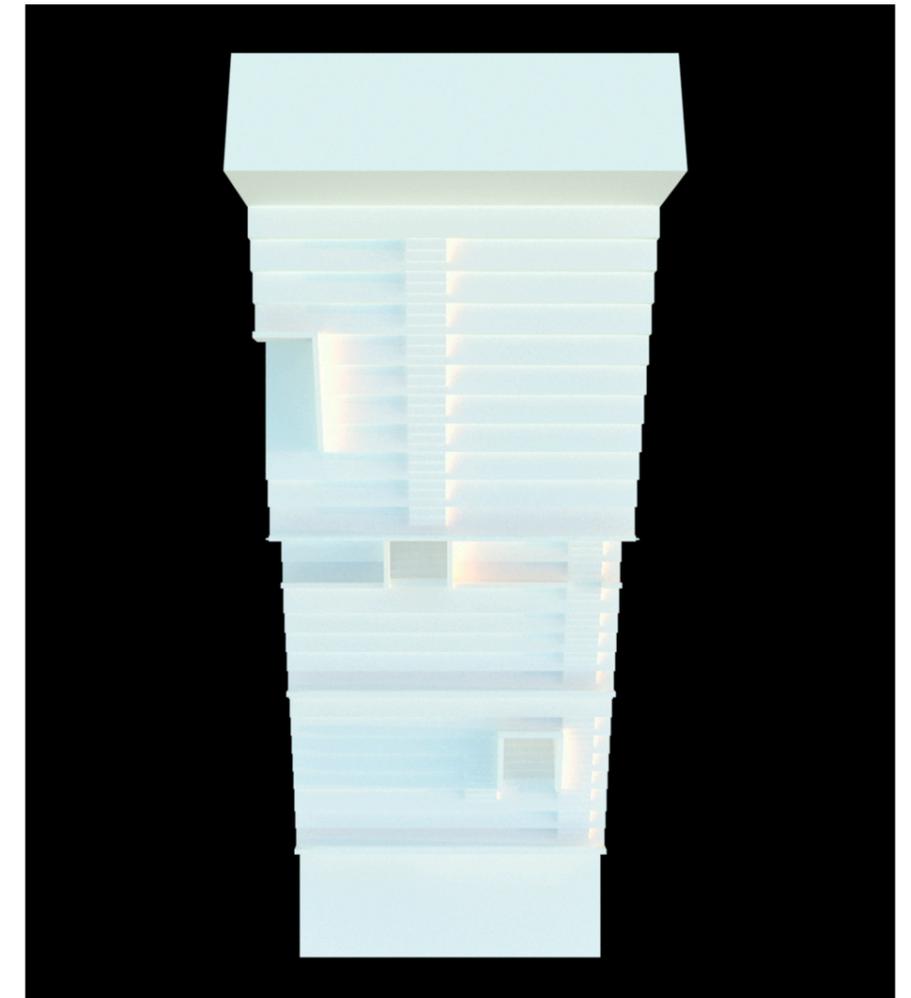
Renderización en planta de una sección del graderío noreste, de la propuesta. Elaboración propia.
